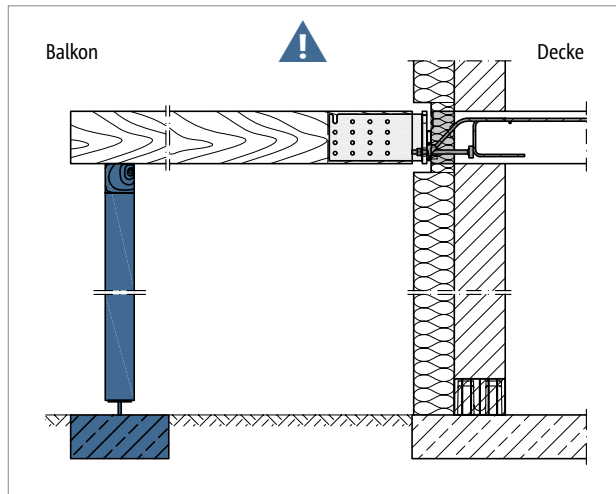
Schöck Isokorb® T Typ SQ mit Stahlschwert: Stützung durchgängig erforderlich
